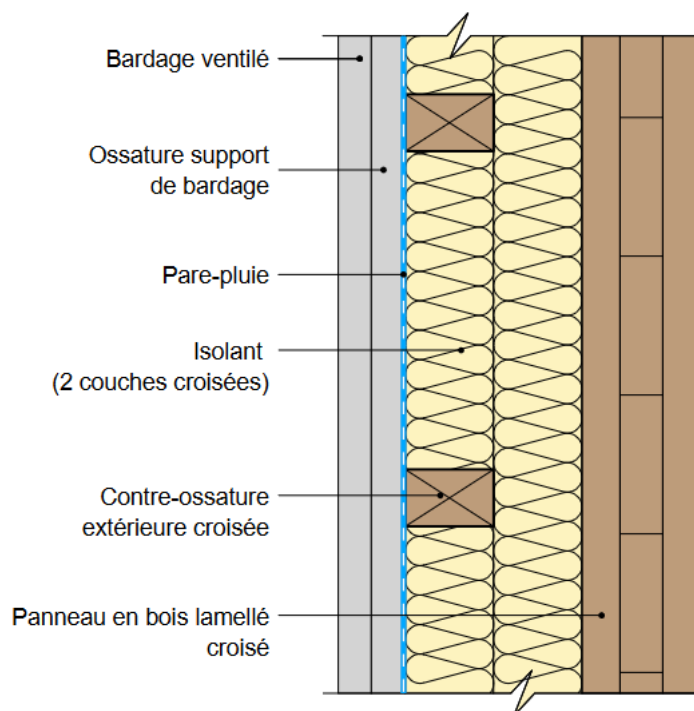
Paroi CLT isolée par l'extérieur avec système pare-pluie ou de protection à l'eau souple sur support discontinu (coupe verticale)
